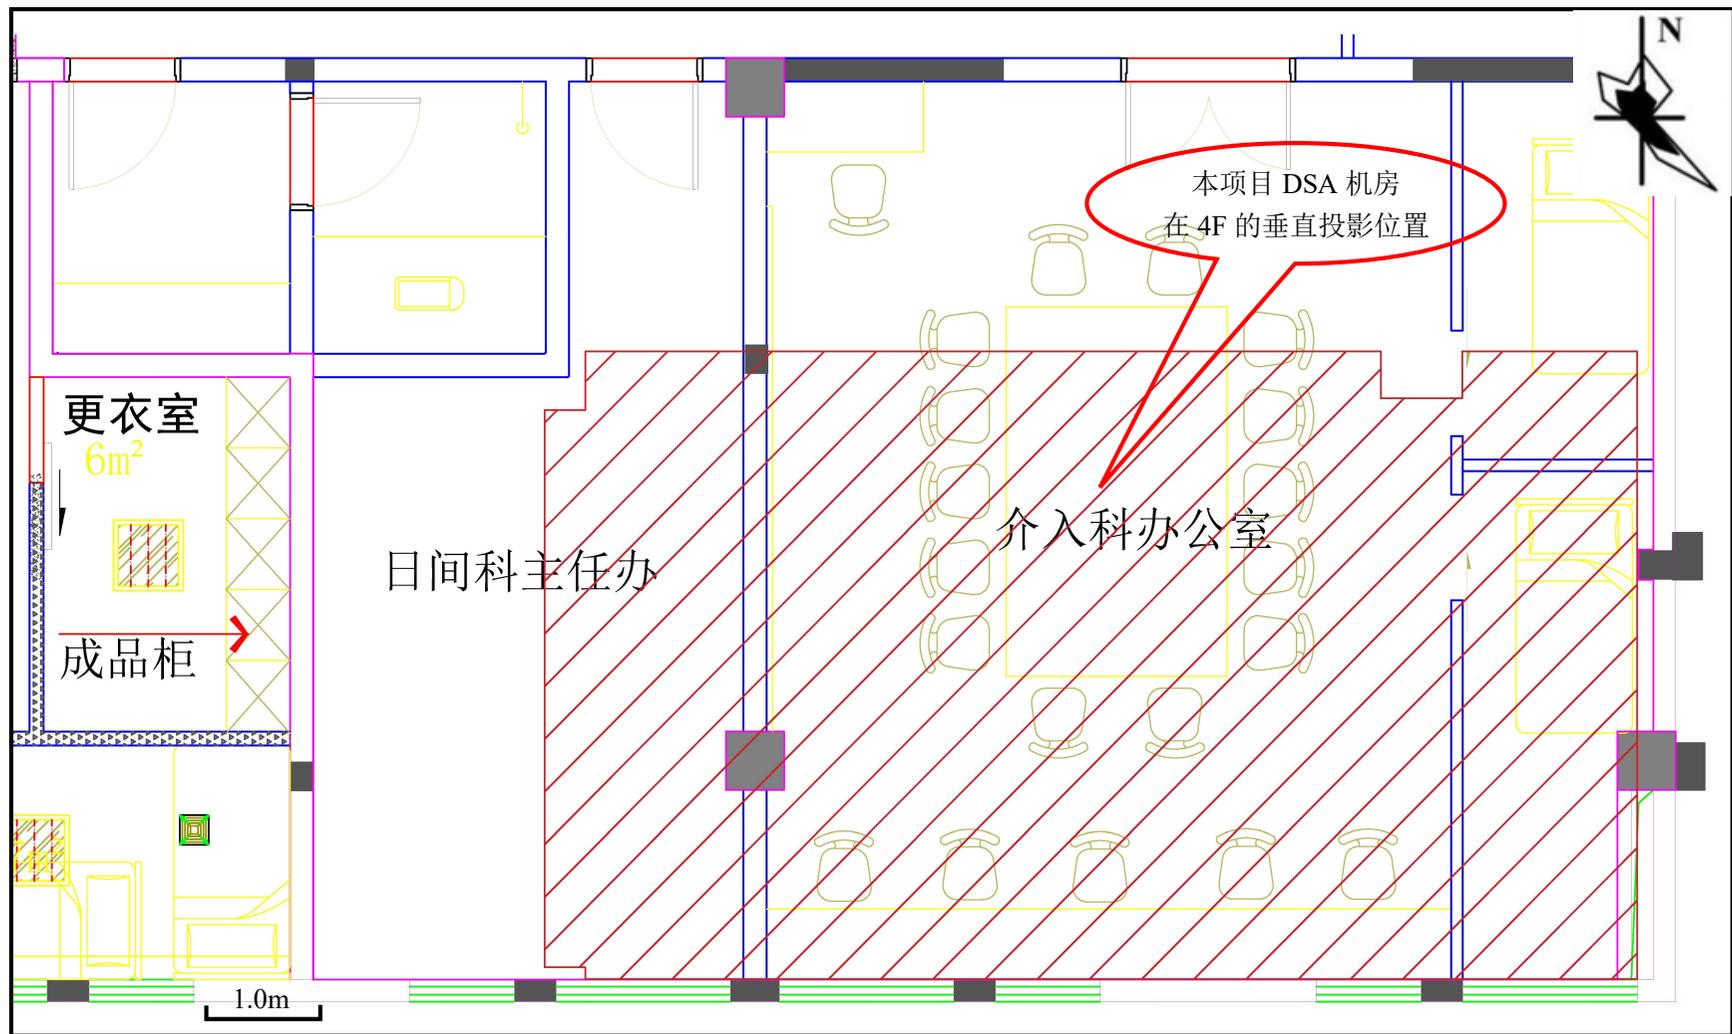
福建省肿瘤医院内科大楼 4 层（局部）平面布置图
